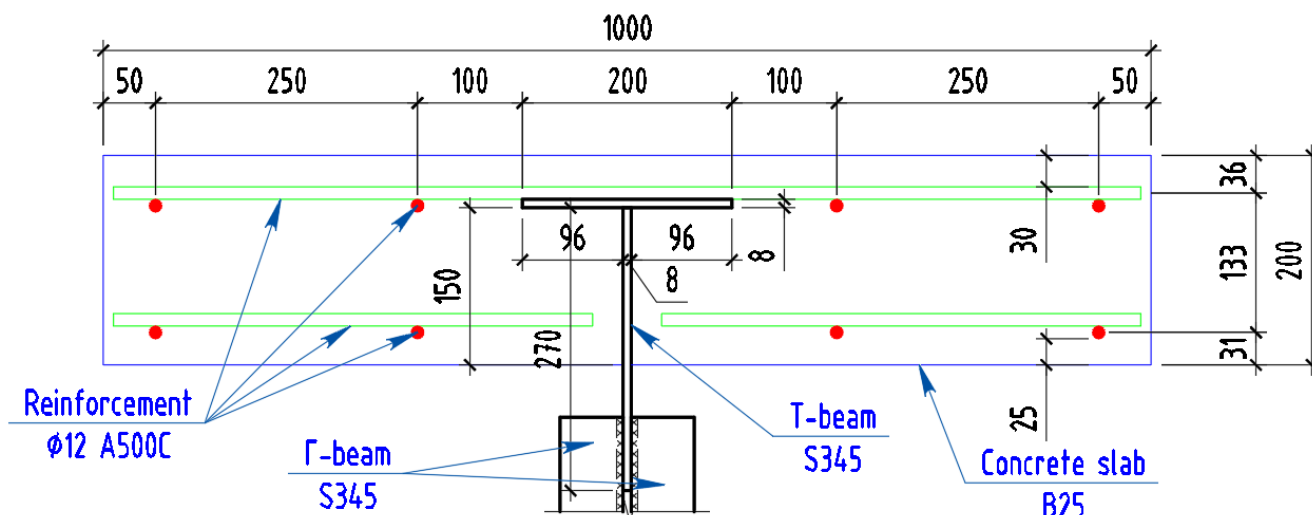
Исследуемое сечение фрагмент верхнего пояса
